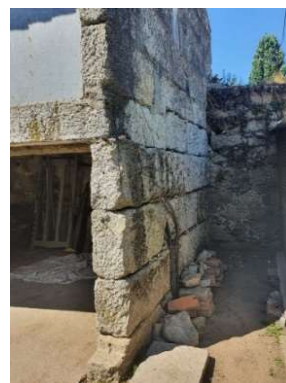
Parede em cantaria de pedra de folha simples, (Esposende).
